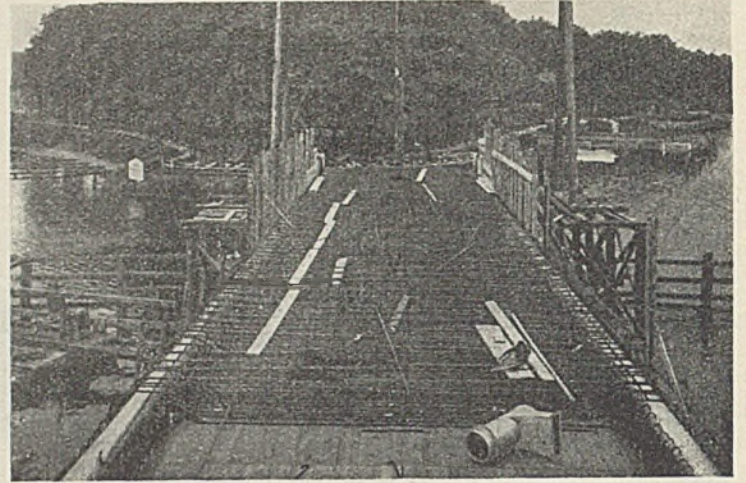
Bauabschnitt I. Einlegen der Entlüftungsrohre.
